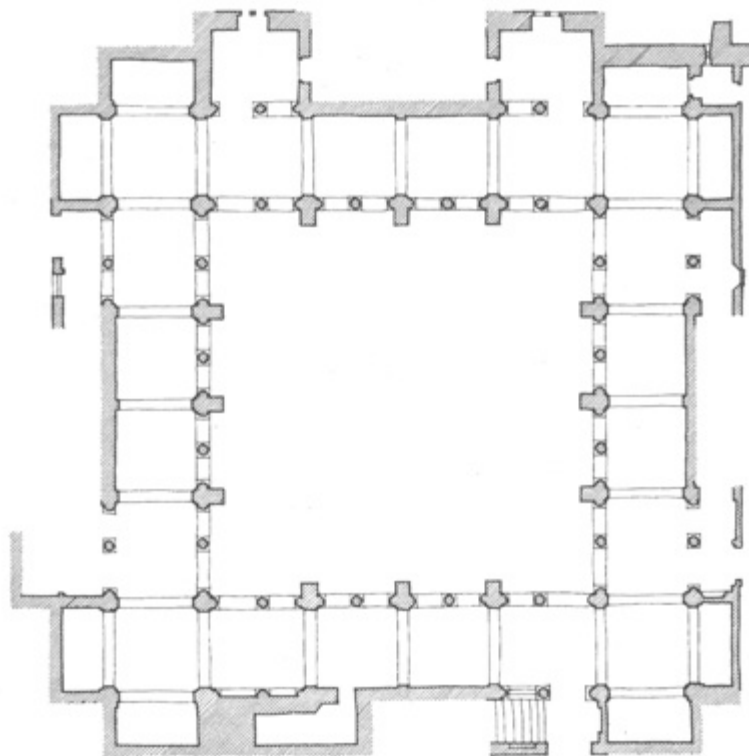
| Planta do primeiro claustro principal do Convento de Cristo de João de Castilho – Adaptado de Kubler
